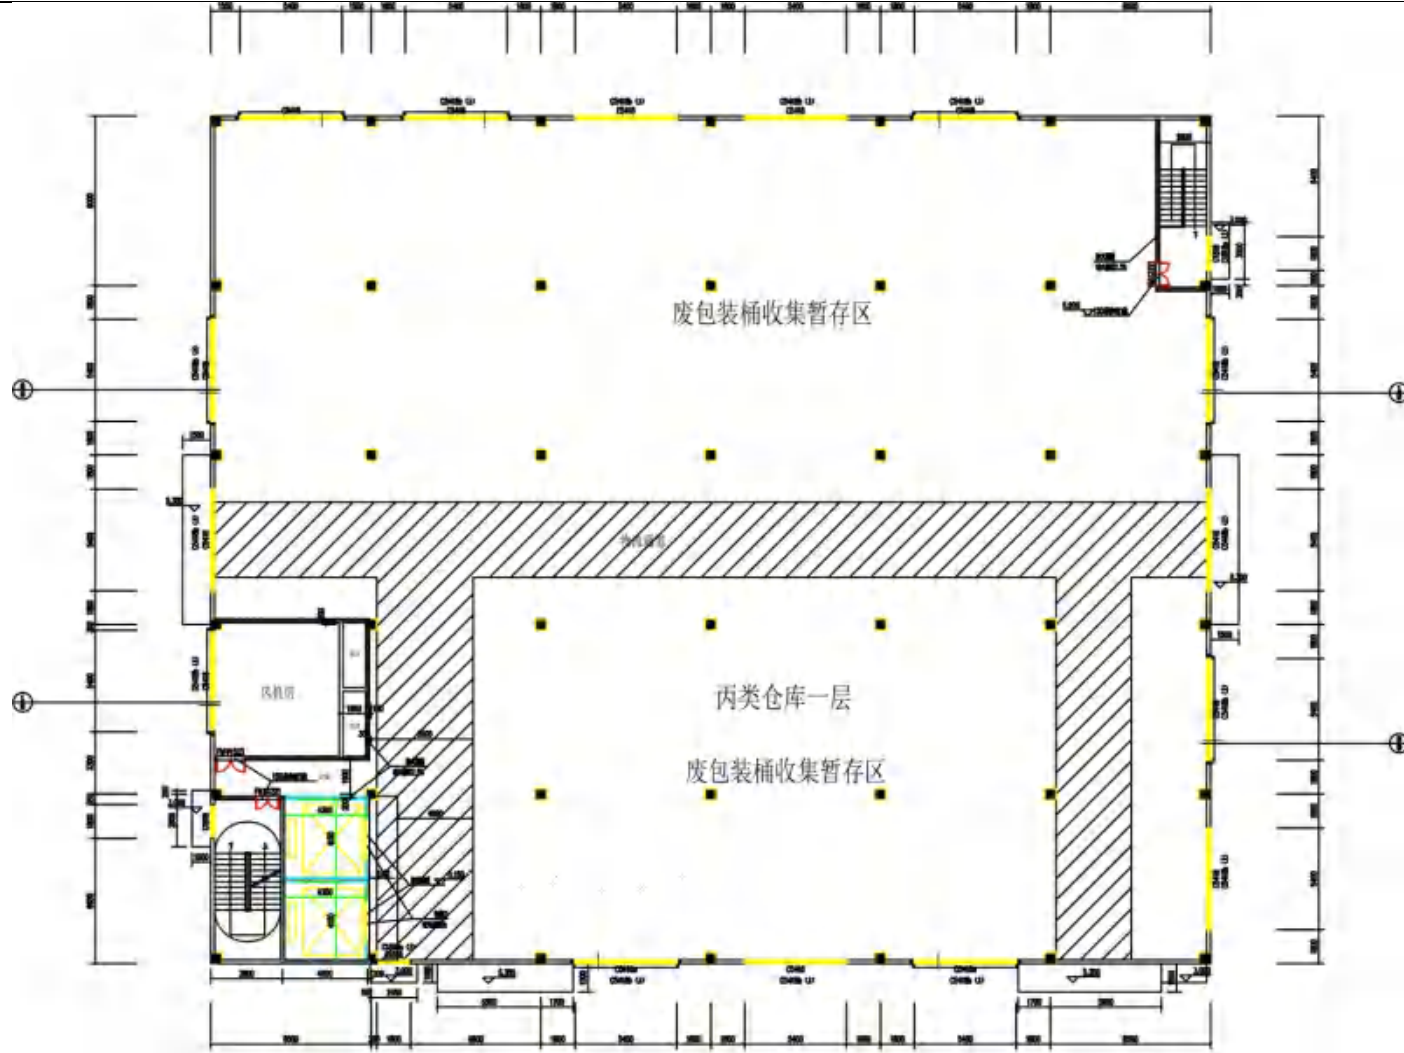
原技改扩建项目丙类仓库 1 层平面布置图
